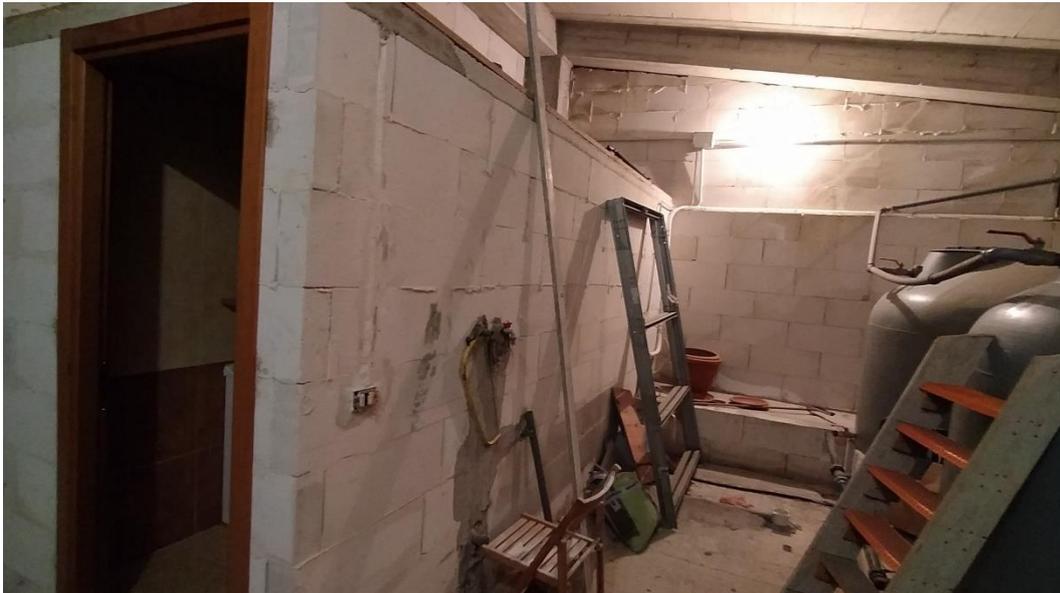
w.c. e locale riserva idrica realizzati al di sotto della rampa d'accesso al primo piano.
